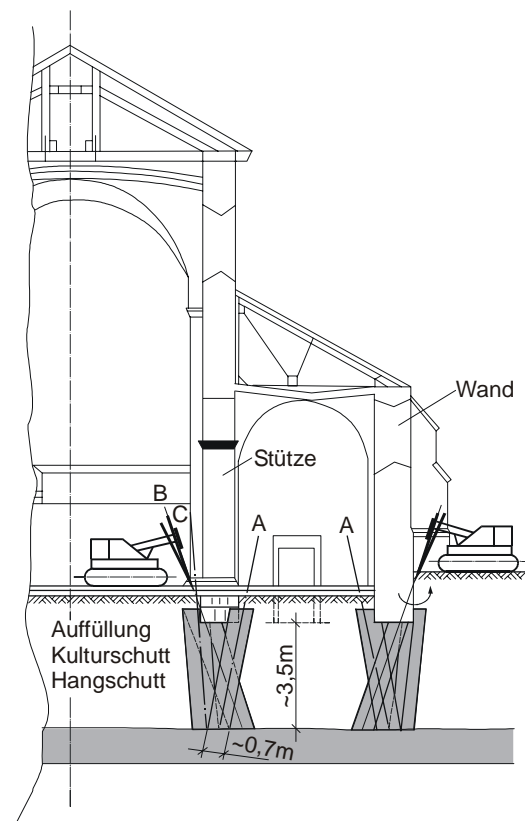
Nachgründung einer Kirche mit dem Düsenstrahlverfahren
